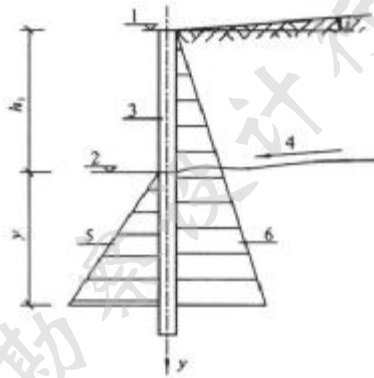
支护桩土质地基横向承载力特征值计算简图
